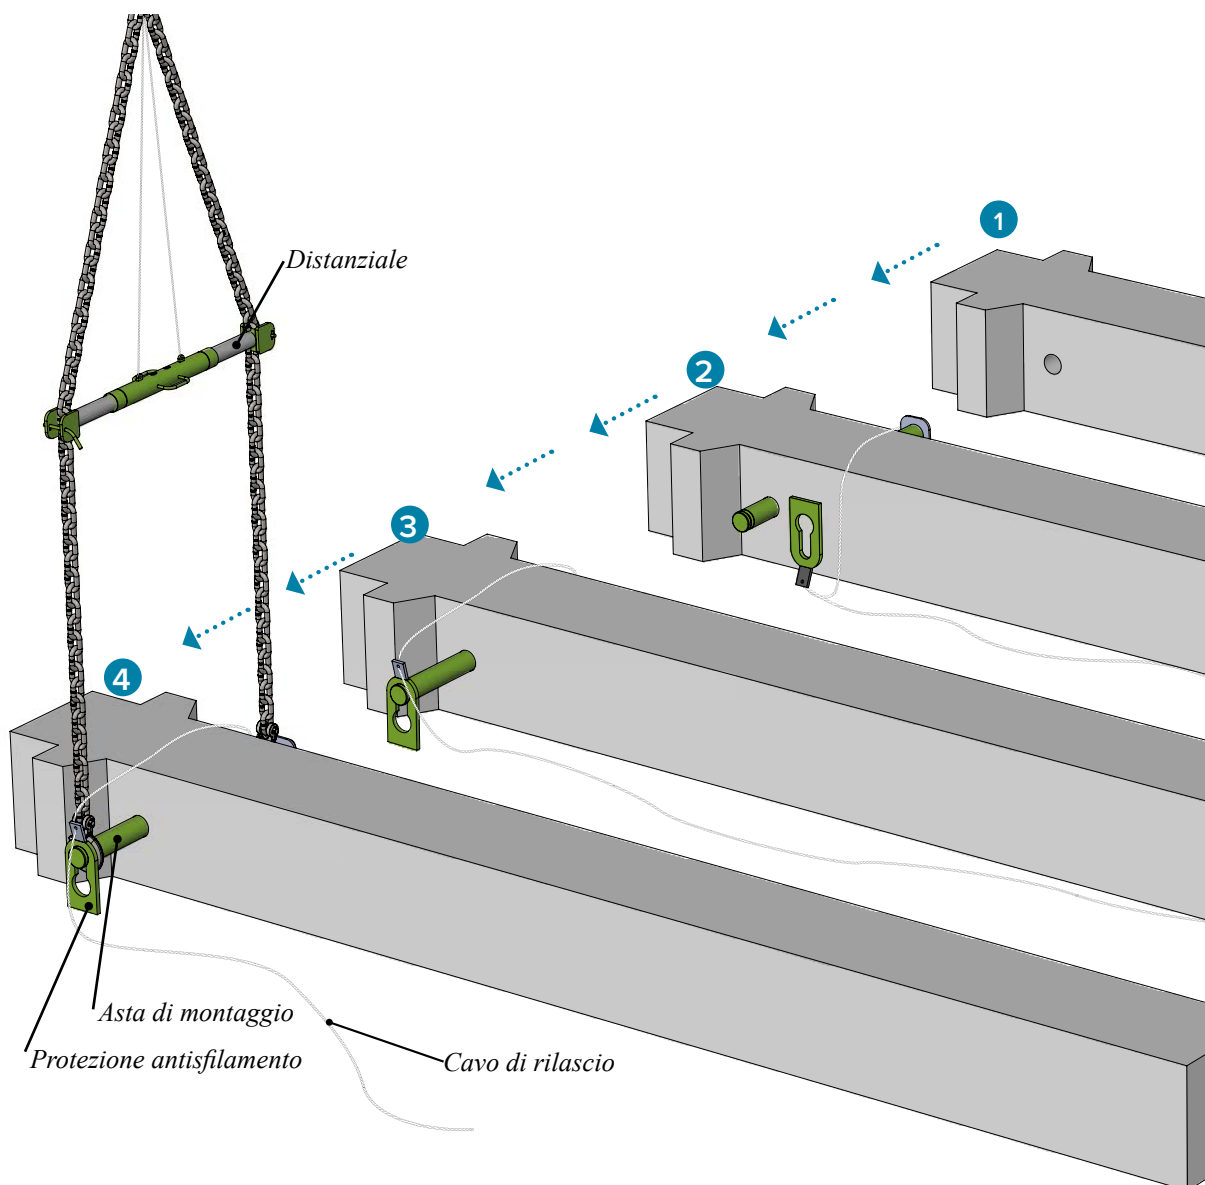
Installazione del Sistema di Montaggio COLIFT nell'elemento prefabbricato.
